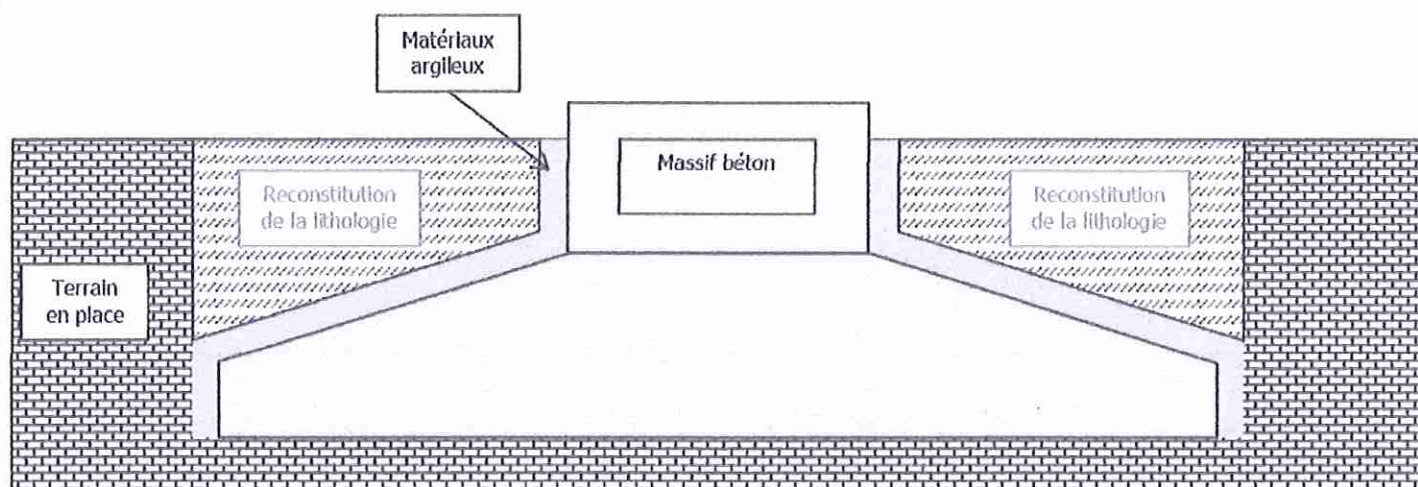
Schéma de mise en place de matériaux argileux entre les terrains en place et les fondations
